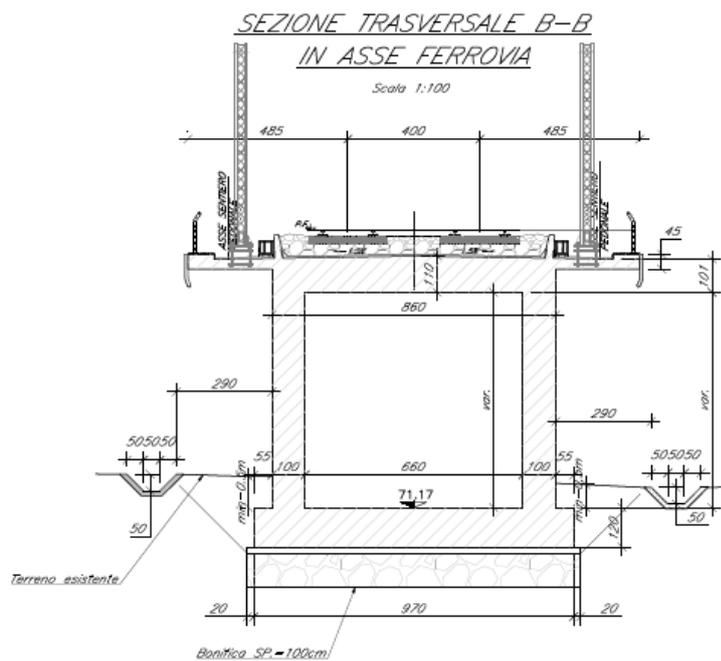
SL22 - Sezione trasversale in asse ferrovia
